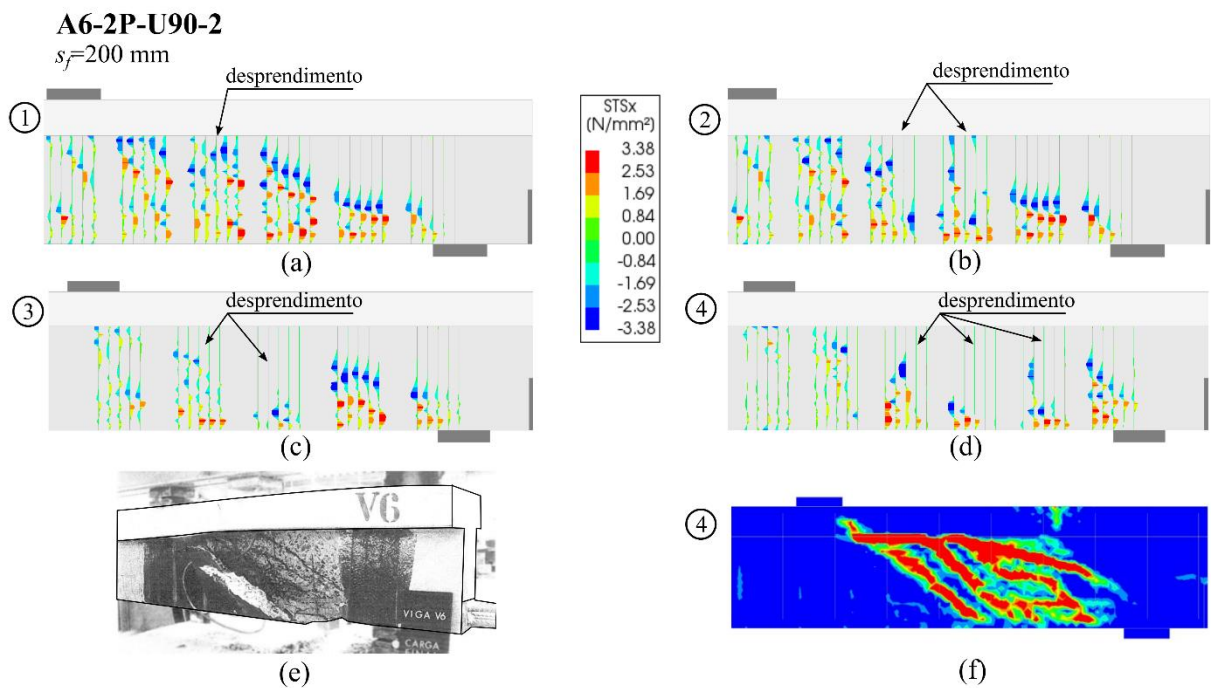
Tensões de aderência entre concreto e FRP para a viga A6-2P-U90-2.
